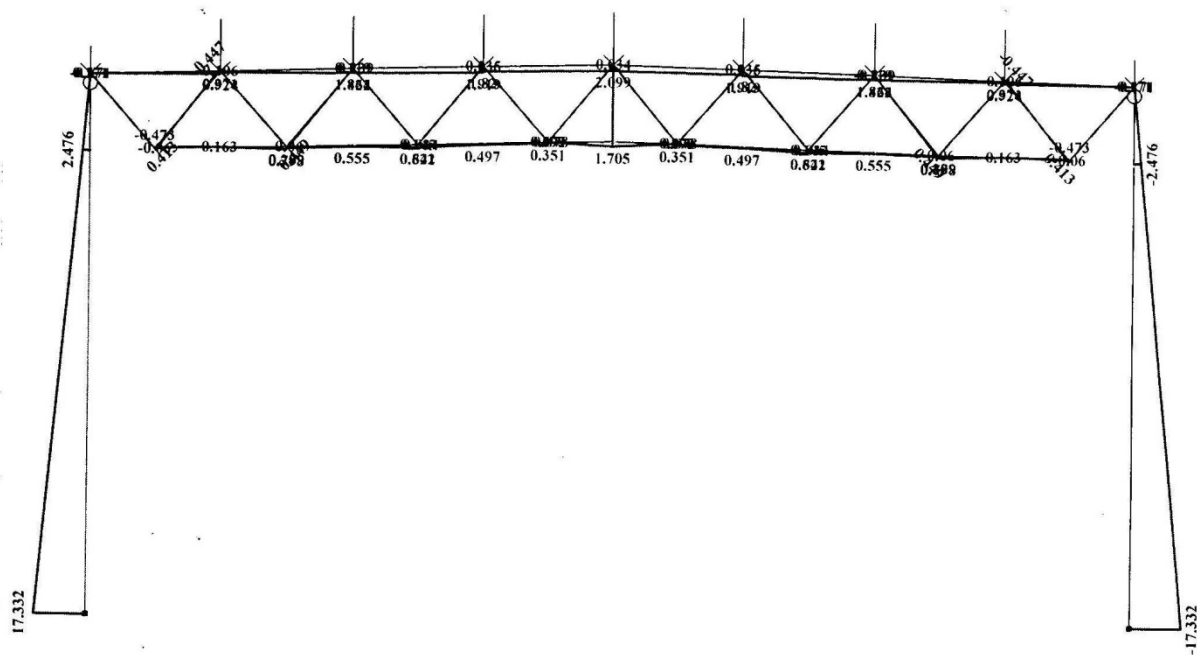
Результаты статического расчета поперечных рам каркасов зданий павильонного типа с решетчатыми ригелями на вертикальную нагрузку
